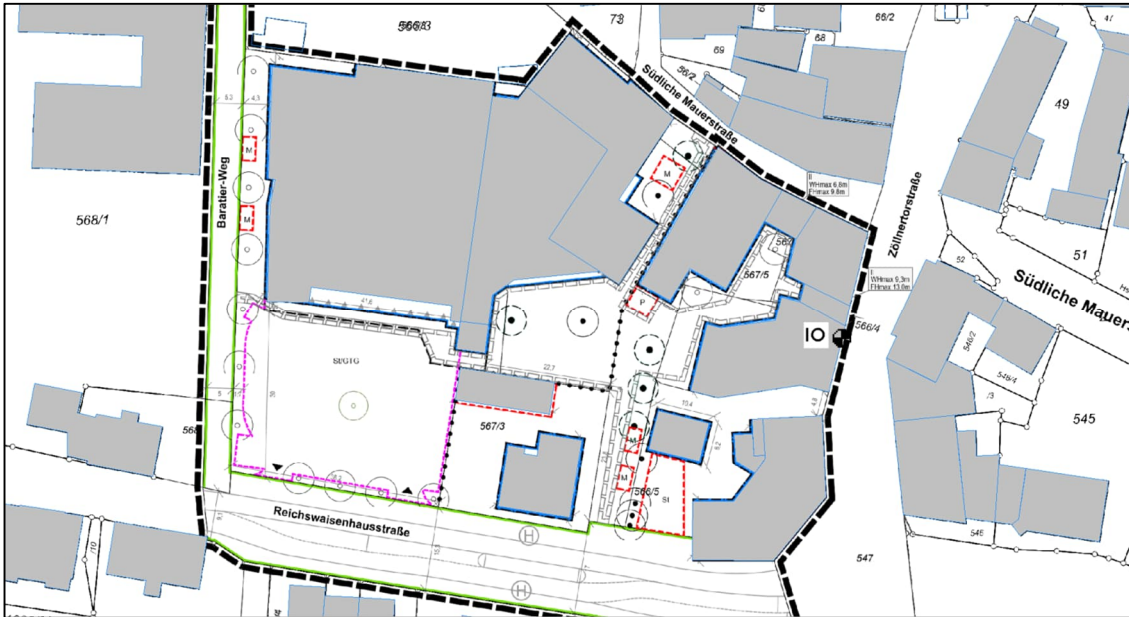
Lageplan /18, 25/ mit Darstellung des maßgeblichen Immissionsortes IO für das Vorhaben zur Beurteilung des Straßenverkehrslärms
